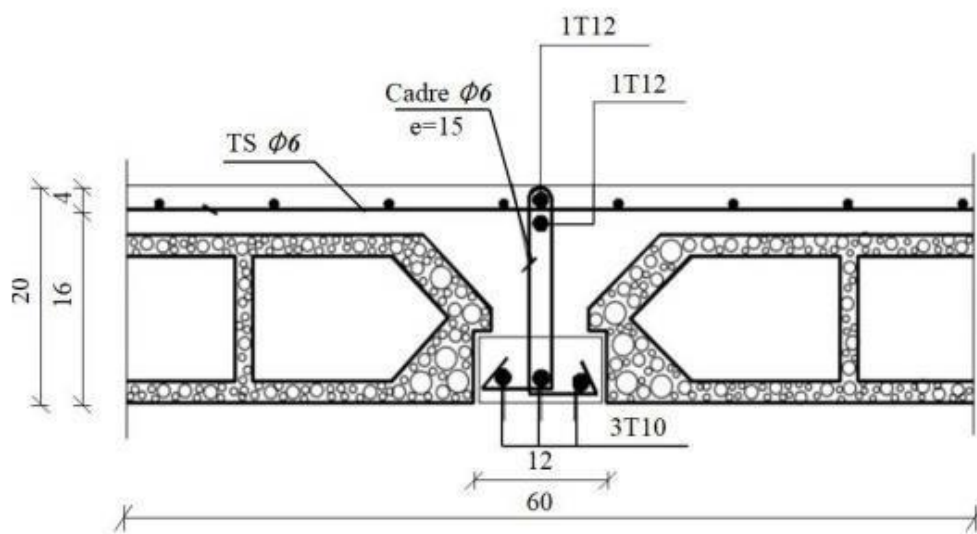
; schéma de ferrailage des armatures transversales
